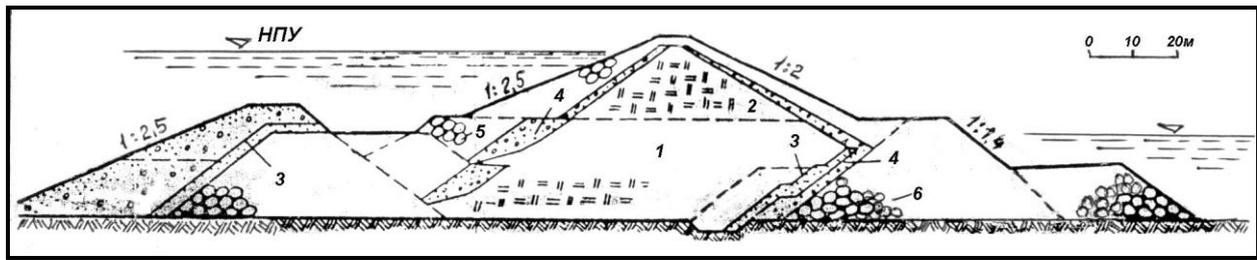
Насыпная плотина Верхне-Тулومского гидроузла на р. Туломе, 1936 г.
